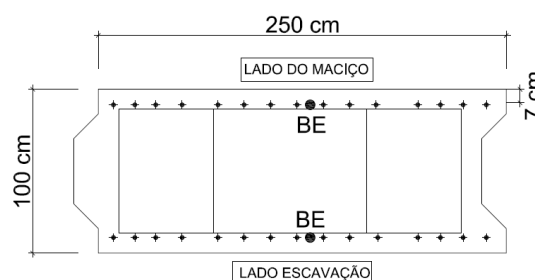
Corte transversal de um painel de parede moldada, 7 cm de recobrimento.
